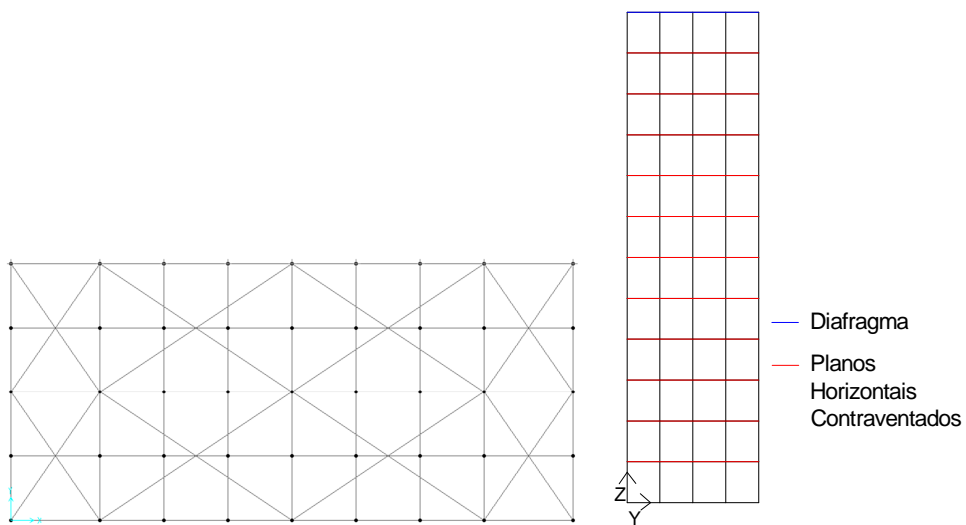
Configuração dos Planos de Contraventamento Horizontal Com Elementos de Contraventamento Grandes
